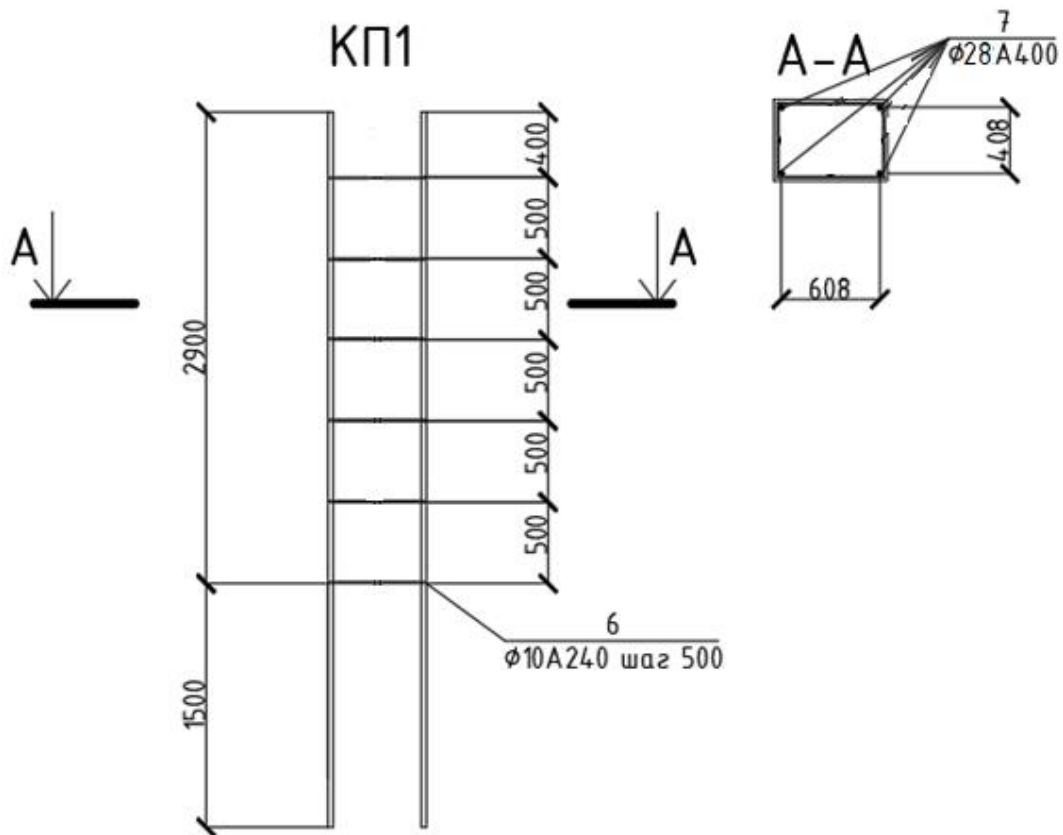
Соединение монолитной железобетонной колонны с монолитным фундаментом
